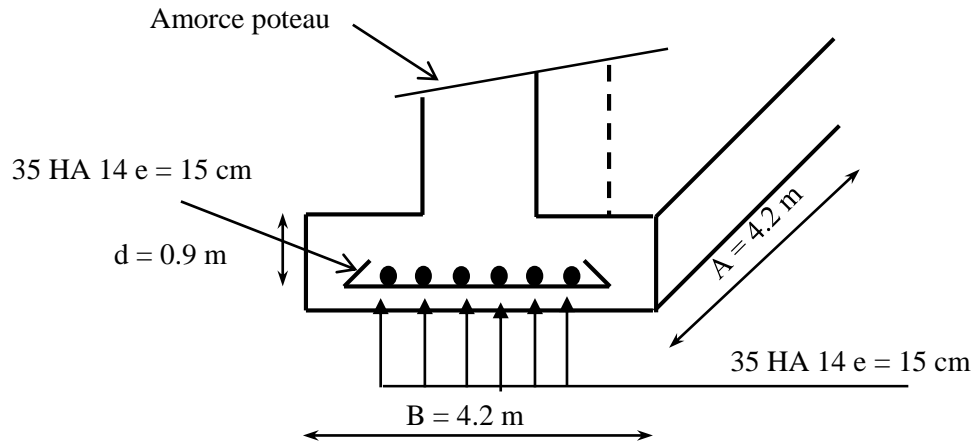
Le schéma de ferrailage d'un semelle isolée (4.2 x 4.2) m²
